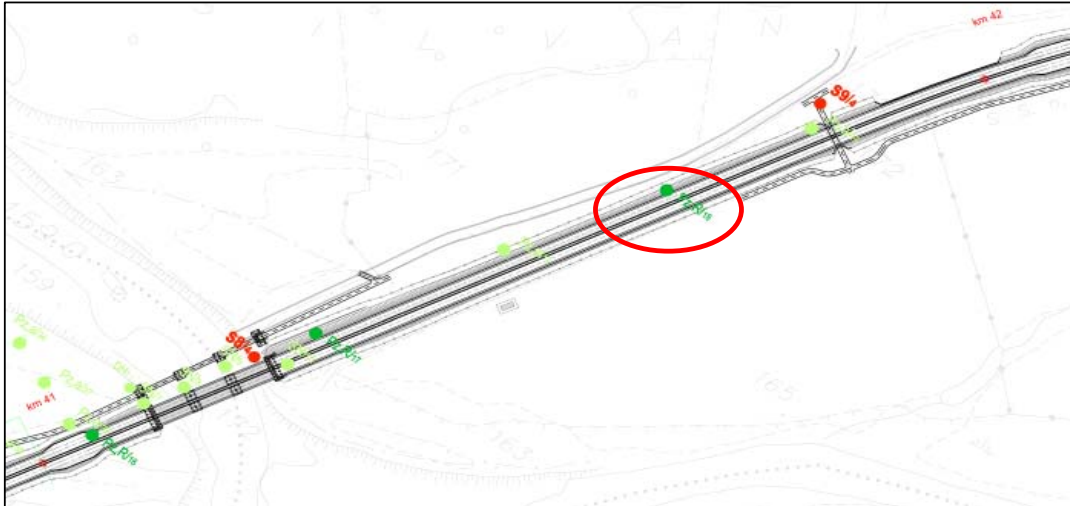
FOTO SATELLITARE CON PROIEZIONE DEL POZZETTO PZR 18
